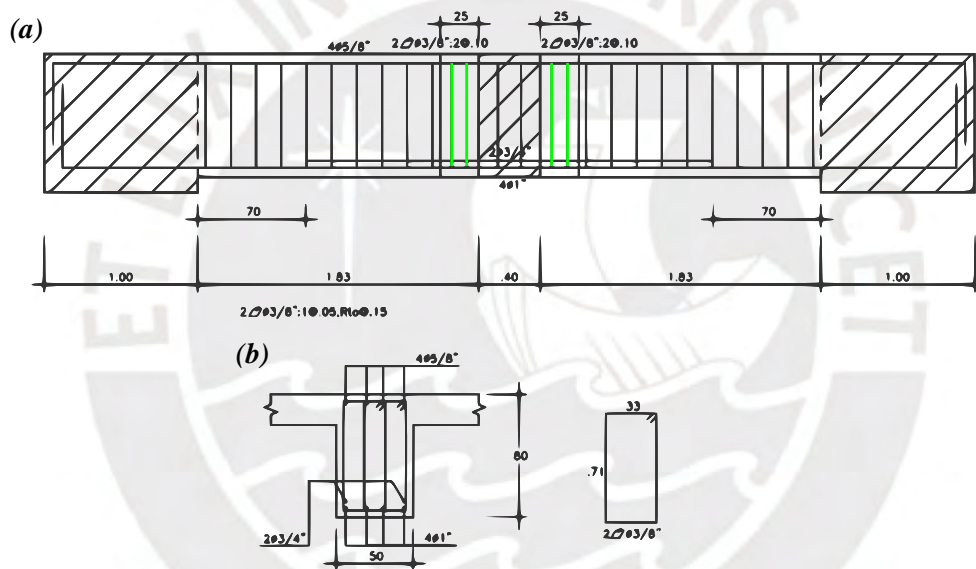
Armadura refuerzo en una viga del sistema de aislamiento: a) vista de la elación; y b) vista de la sección transversal.
